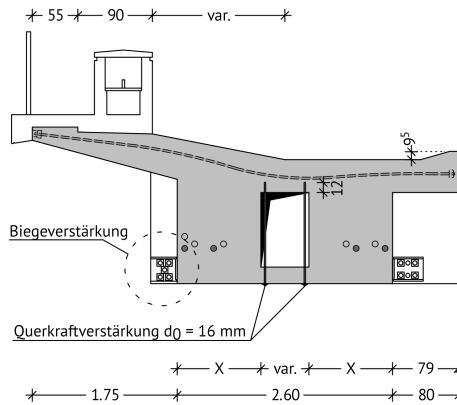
Nachträgliche Biegezugverstärkung mit Stahllamellen als externe Bewehrung und Querkraftverstärkung mit Betonschrauben, Planauszug Prof. Feix Ingenieure GmbH
